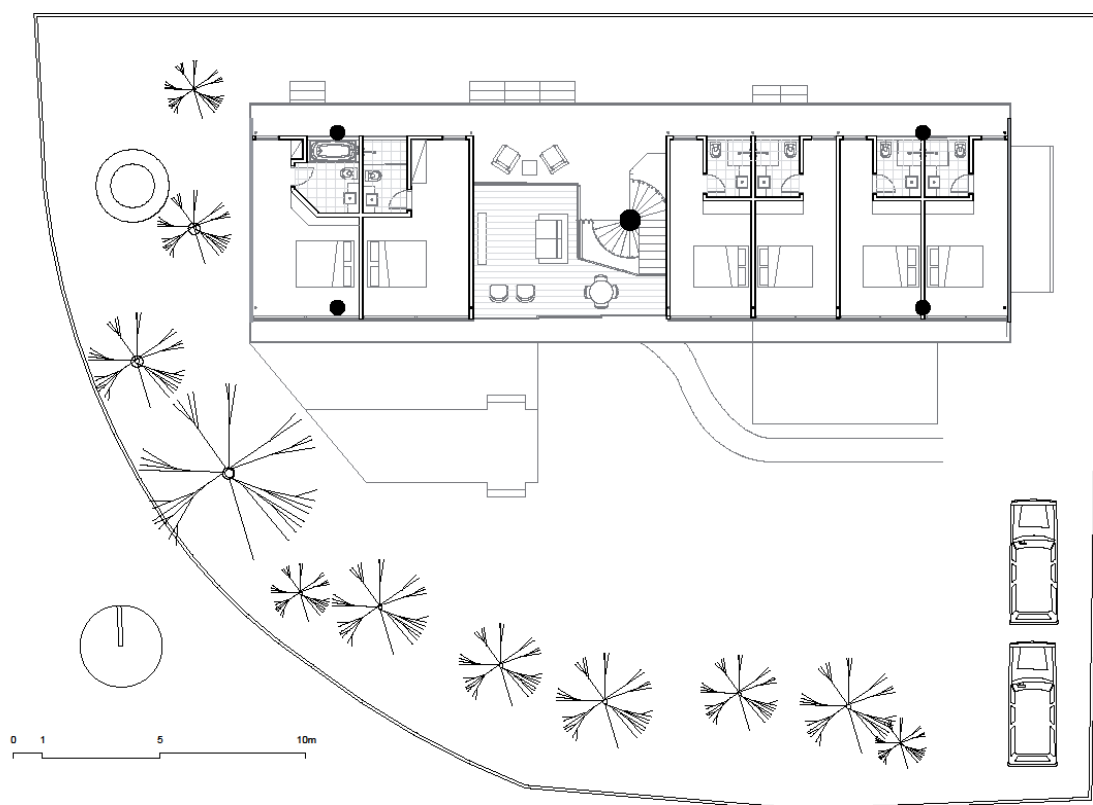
Planta Pav1 (sem cor). Fonte: AUTOR (2017).
